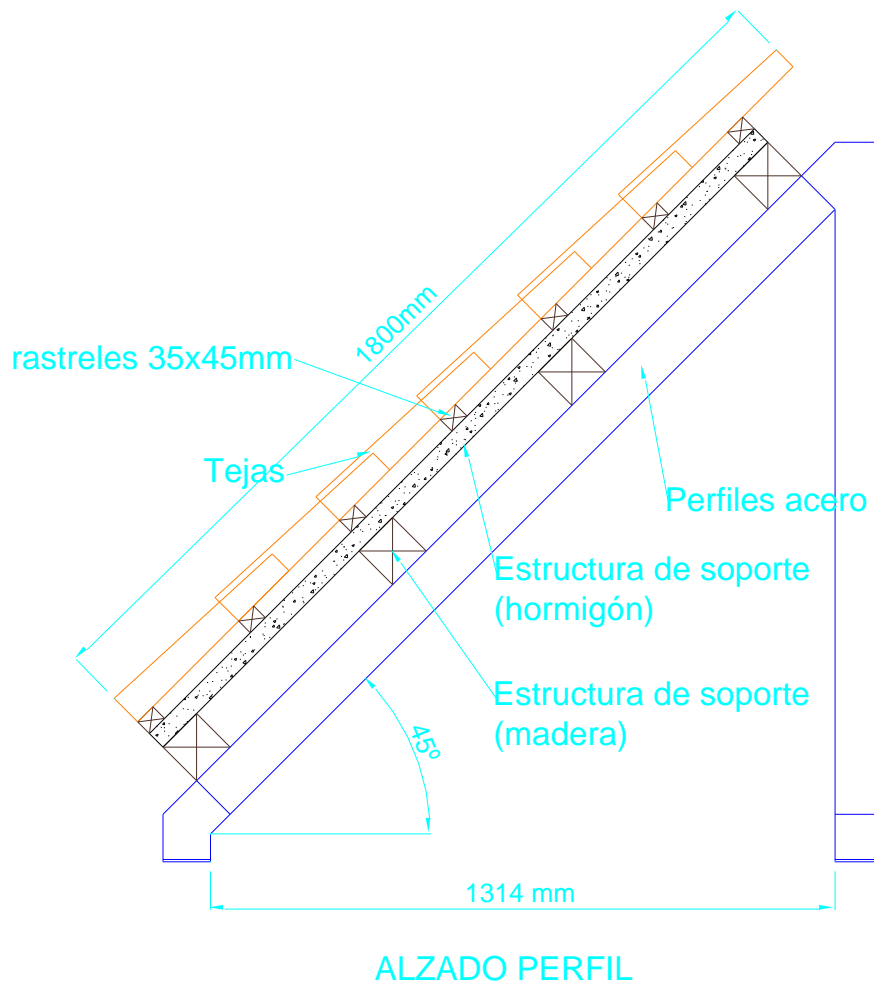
Perfil de la estructura de soporte con la disposición de las tejas
